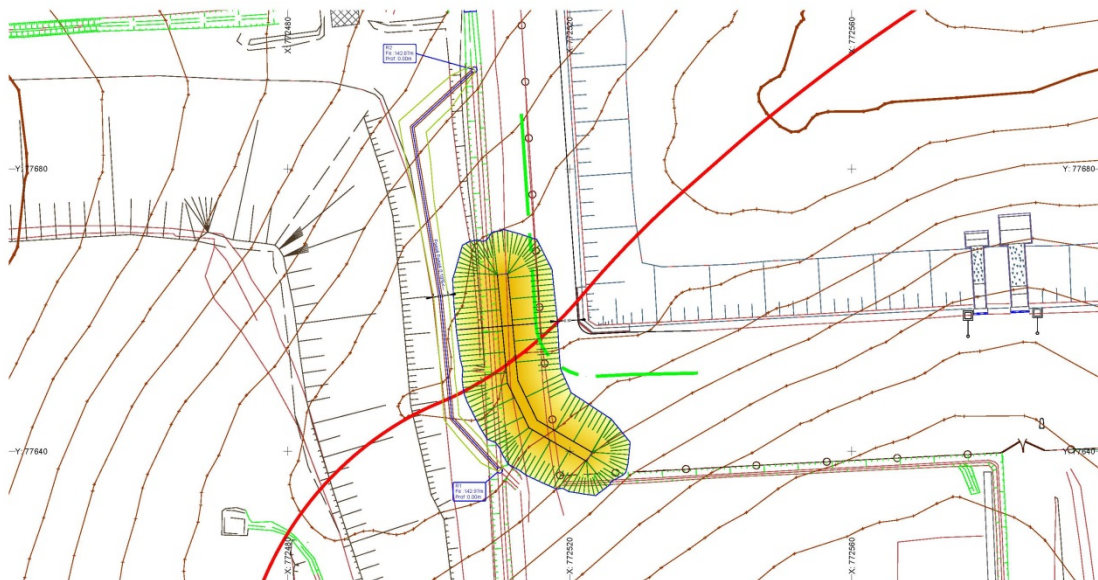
Plan d'implantation prévisionnel de la tranchée (ANDRA - 2019)
